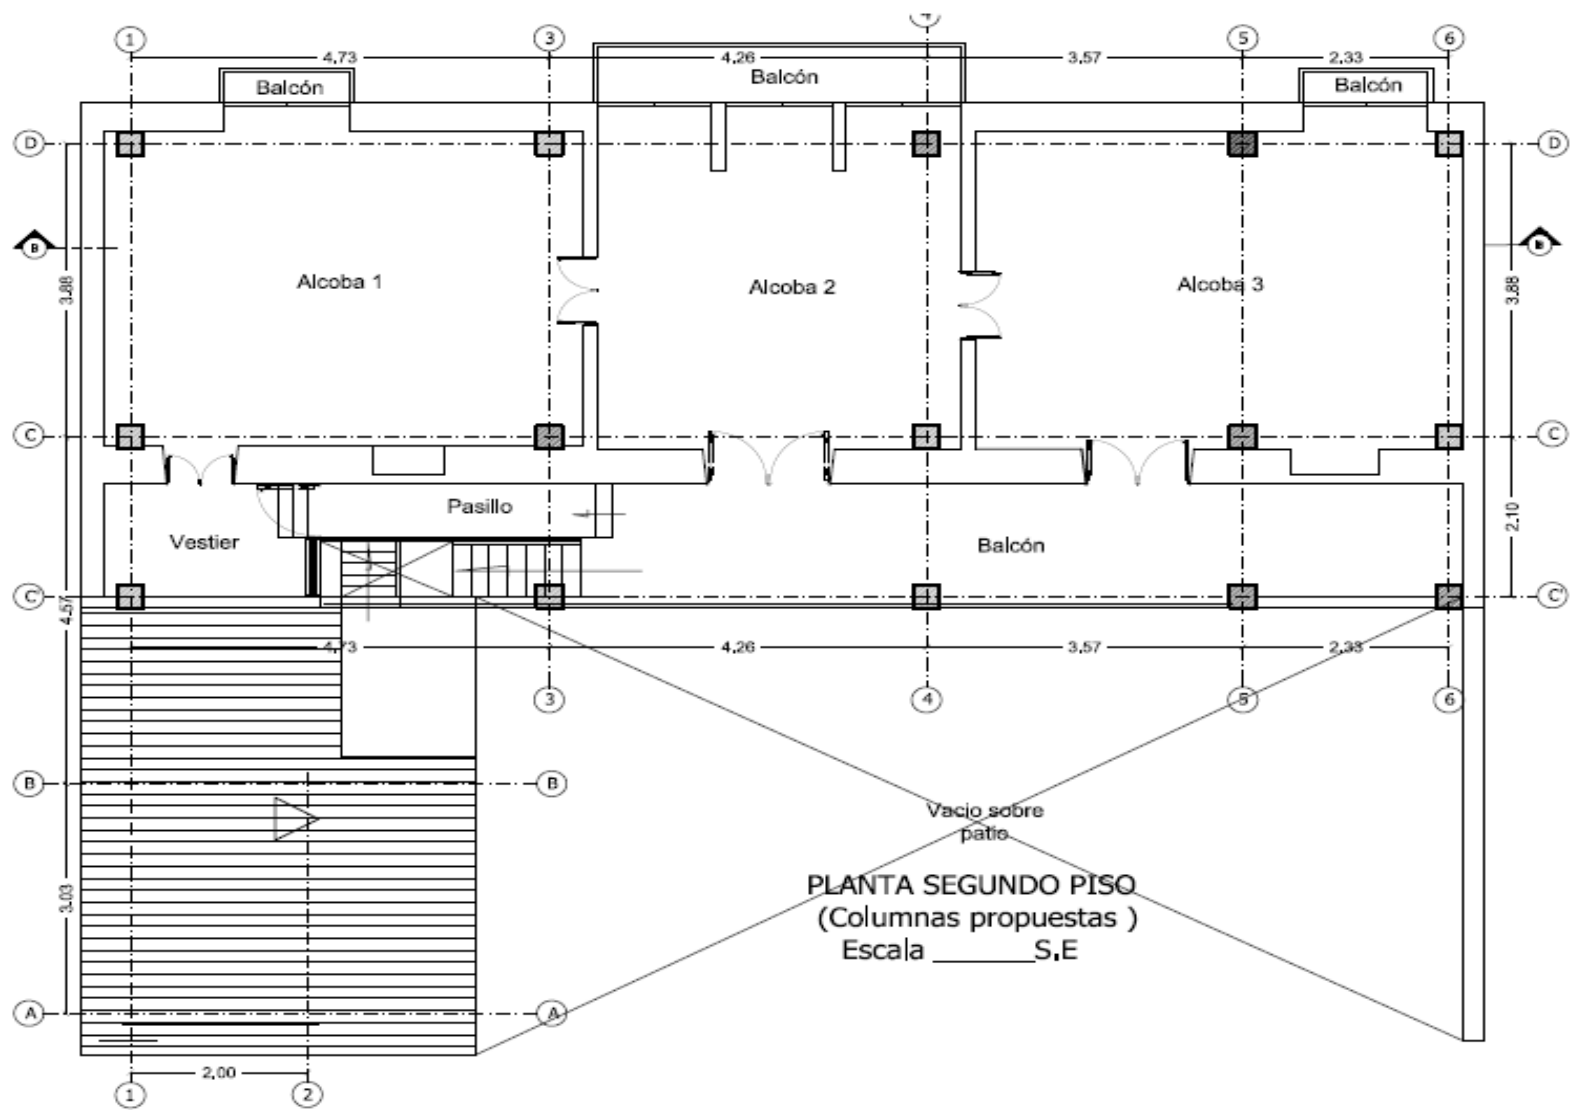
Planta Segundo piso reforzada, ubicación columnas de 0.3 x 0.3
